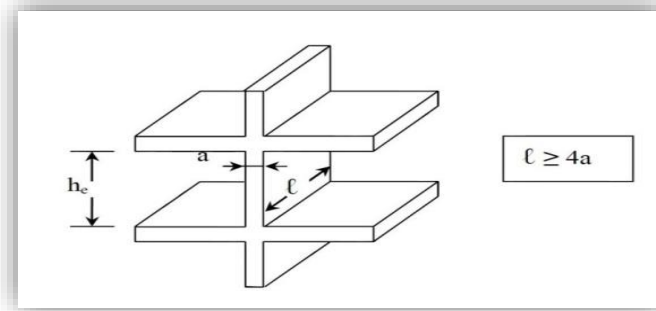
COUPE DE VOILES EN ELEVATION
